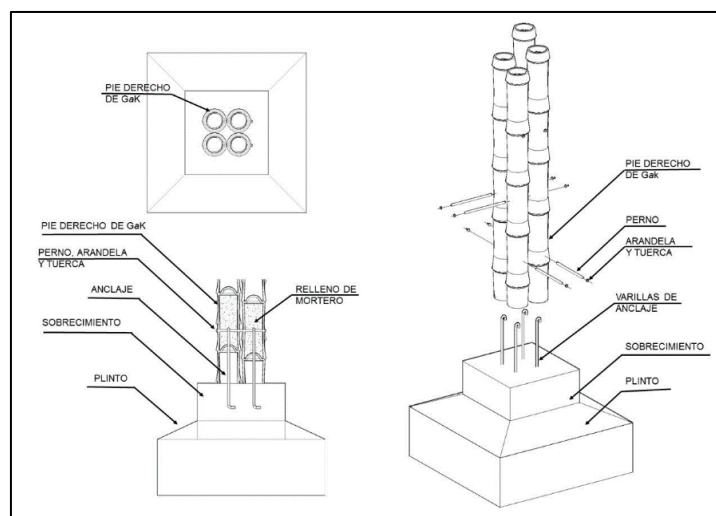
Anclajes sumergidos en concreto Fuente: (NEC-SE-GUADUA, 2016)
